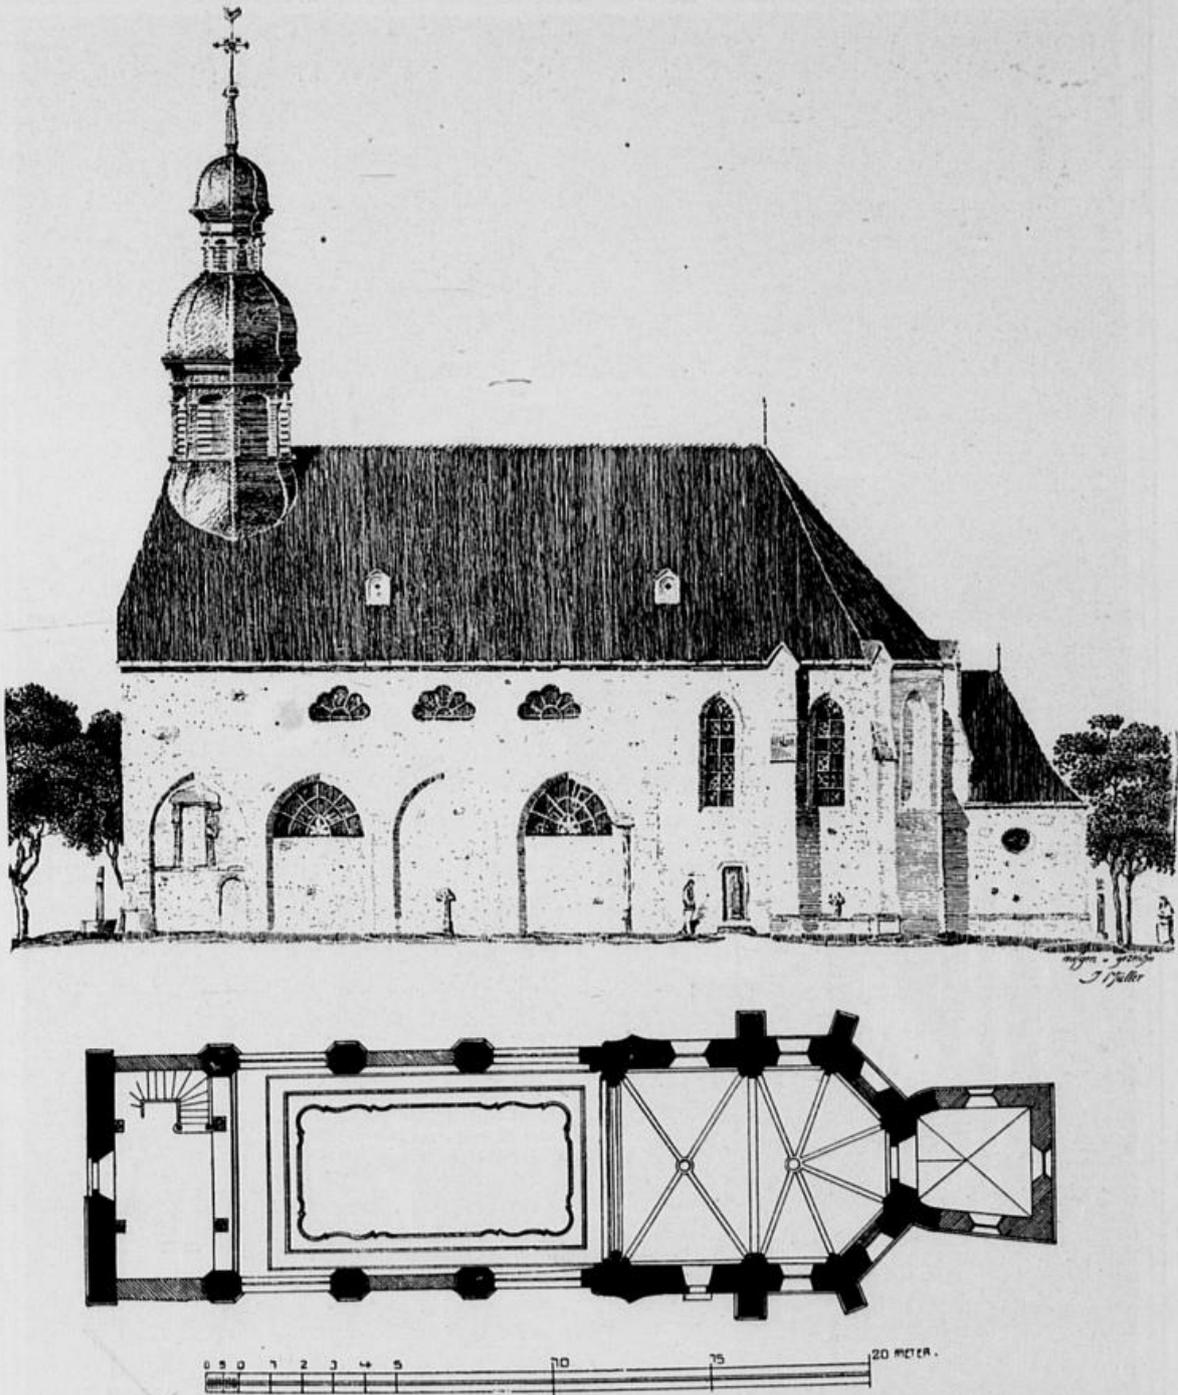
Frankirch. Grundriss und Seitenansicht der Genovevafirche.
